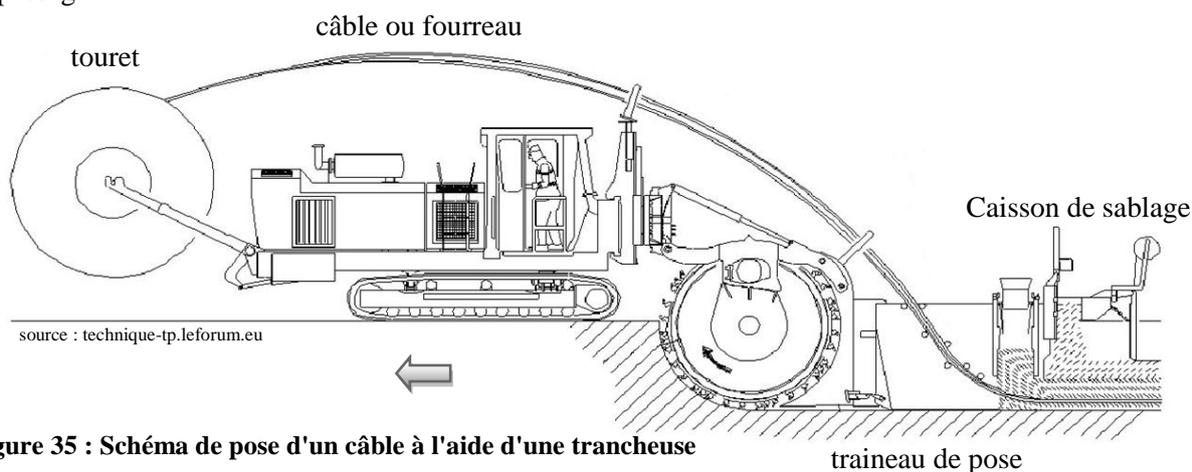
Schéma de pose d'un câble à l'aide d'une trancheuse
